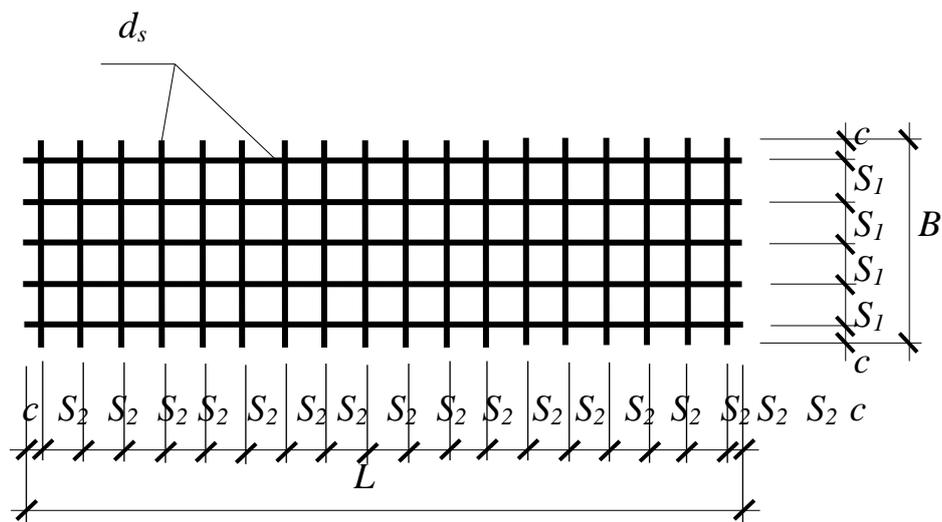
Сітка з робочою арматурою в двох напрямках
